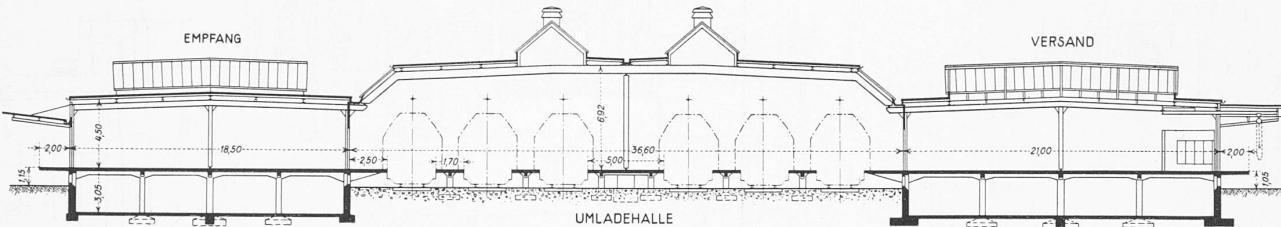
Querschnitt durch Empfangs-, Umlade- und Versandhalle samt Lagerräumen des SBB-Güterbahnhofs Bern-Weiermannshaus. — Maßstab 1:450.
